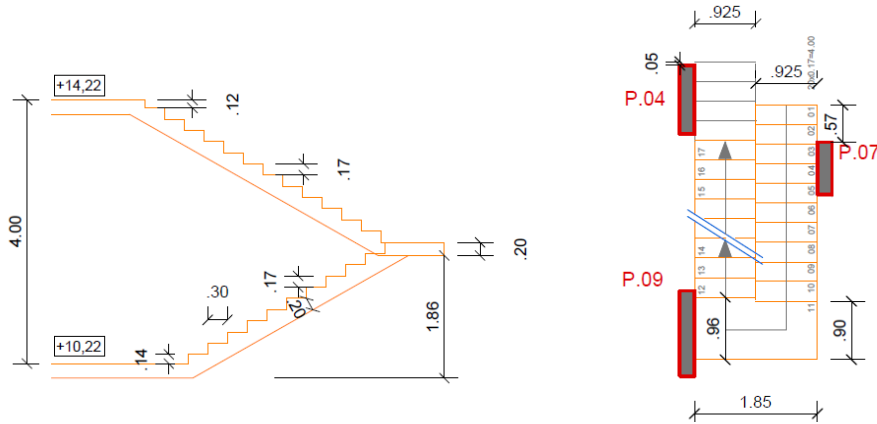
Planta e corte da escada do lote 6.5, piso -1.
